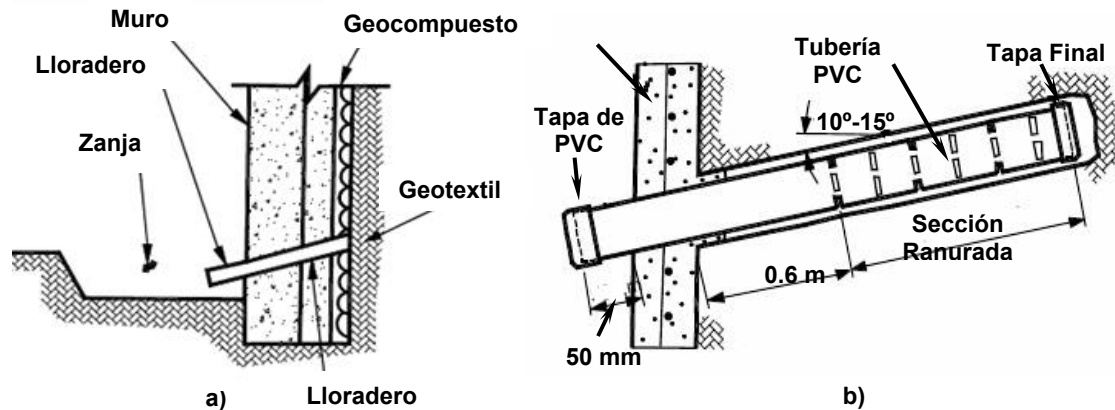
a) Llozadero de PVC en drenaje de pie; b) Llozadero de PVC en la cara del muro.
